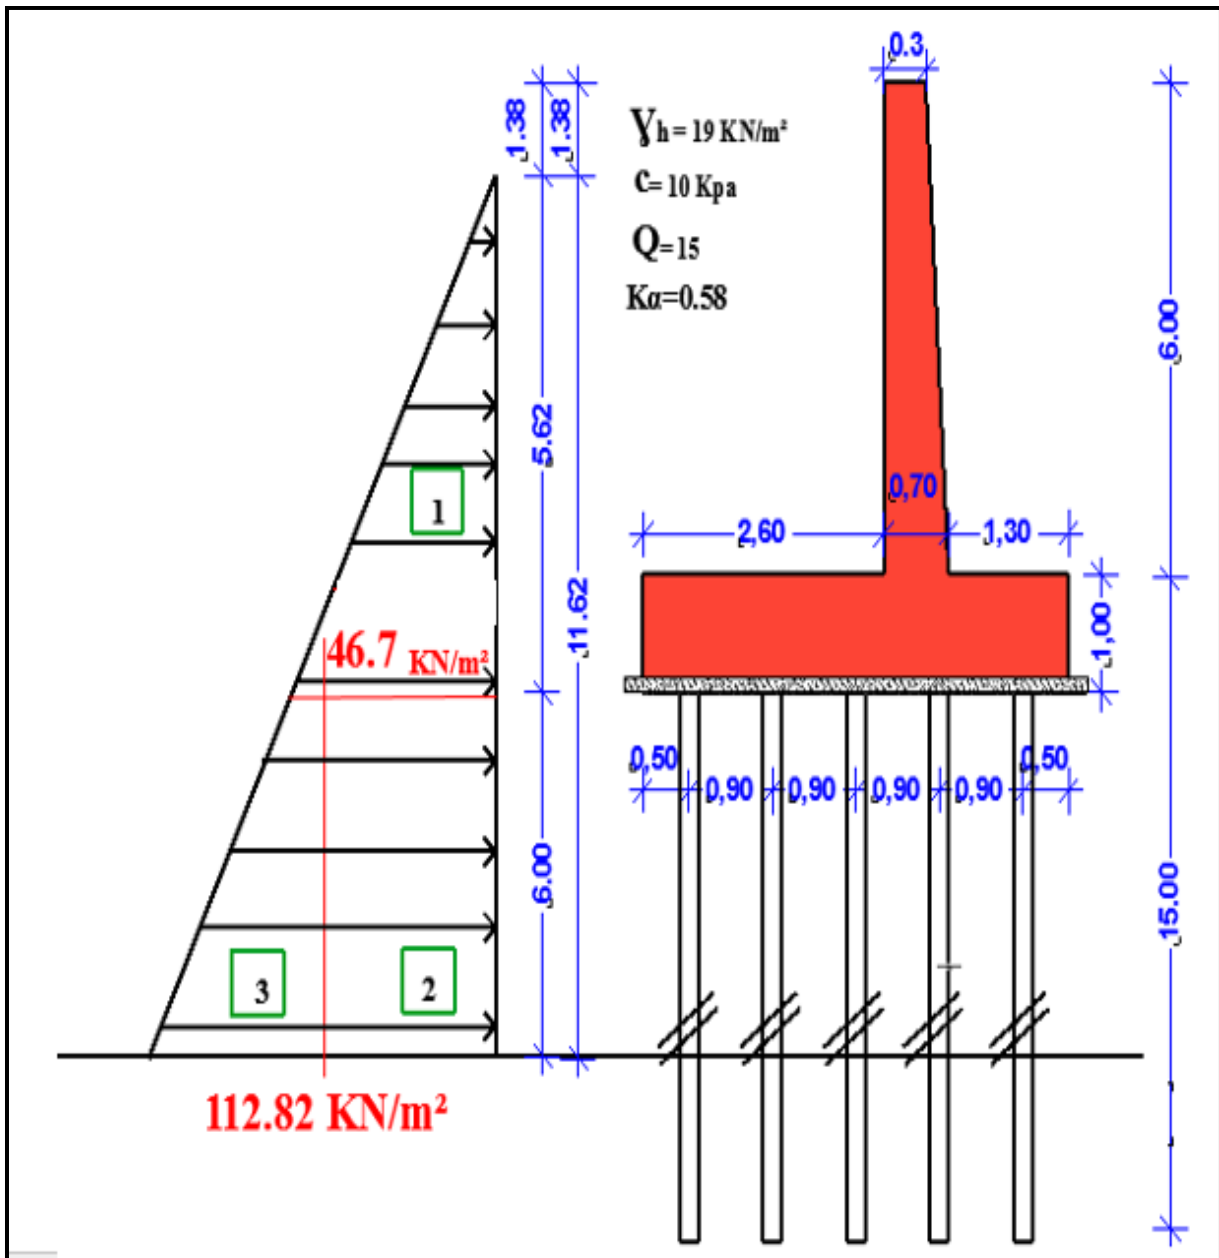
Force horizontal appliqué sur le mur et micro pieux.
